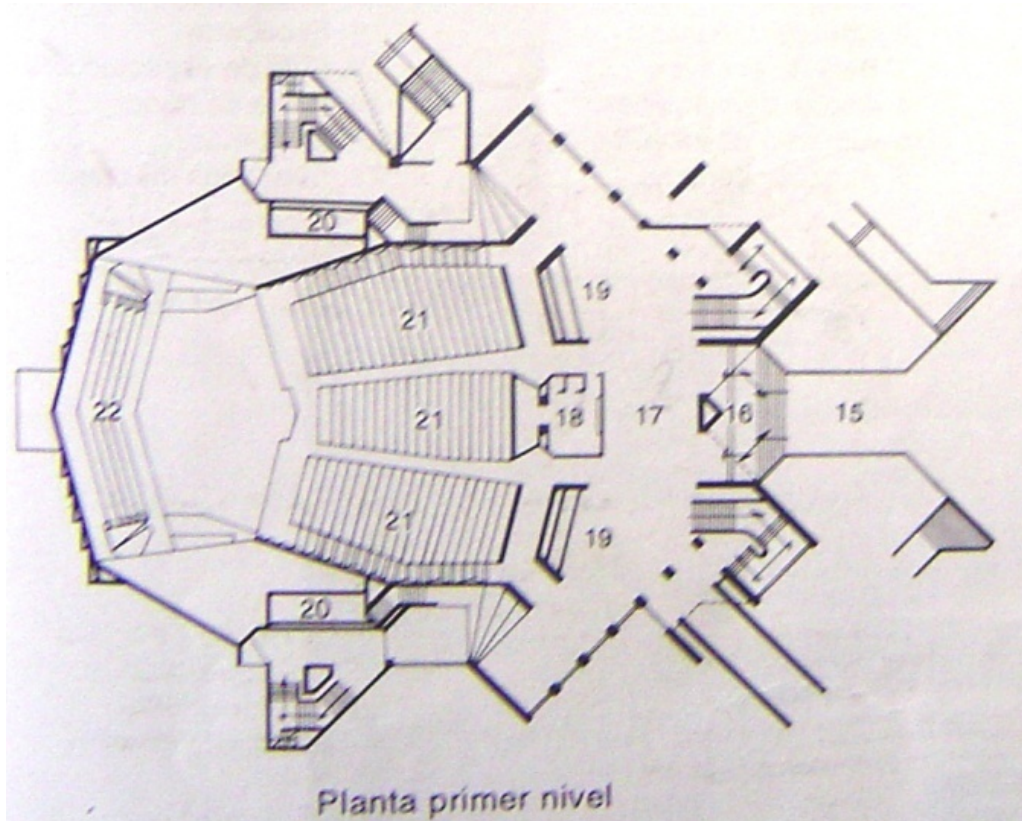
Planta arquitectónica la sala Nezahualcóyotl.
